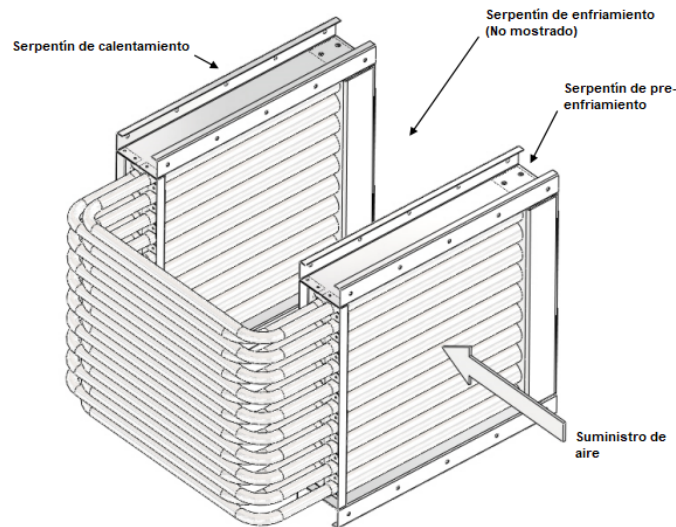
Vista isométrica sistema Wrap Around para tubos de calor. Fuente: (Colmac Coil Manufacturing Inc., 2015b).
